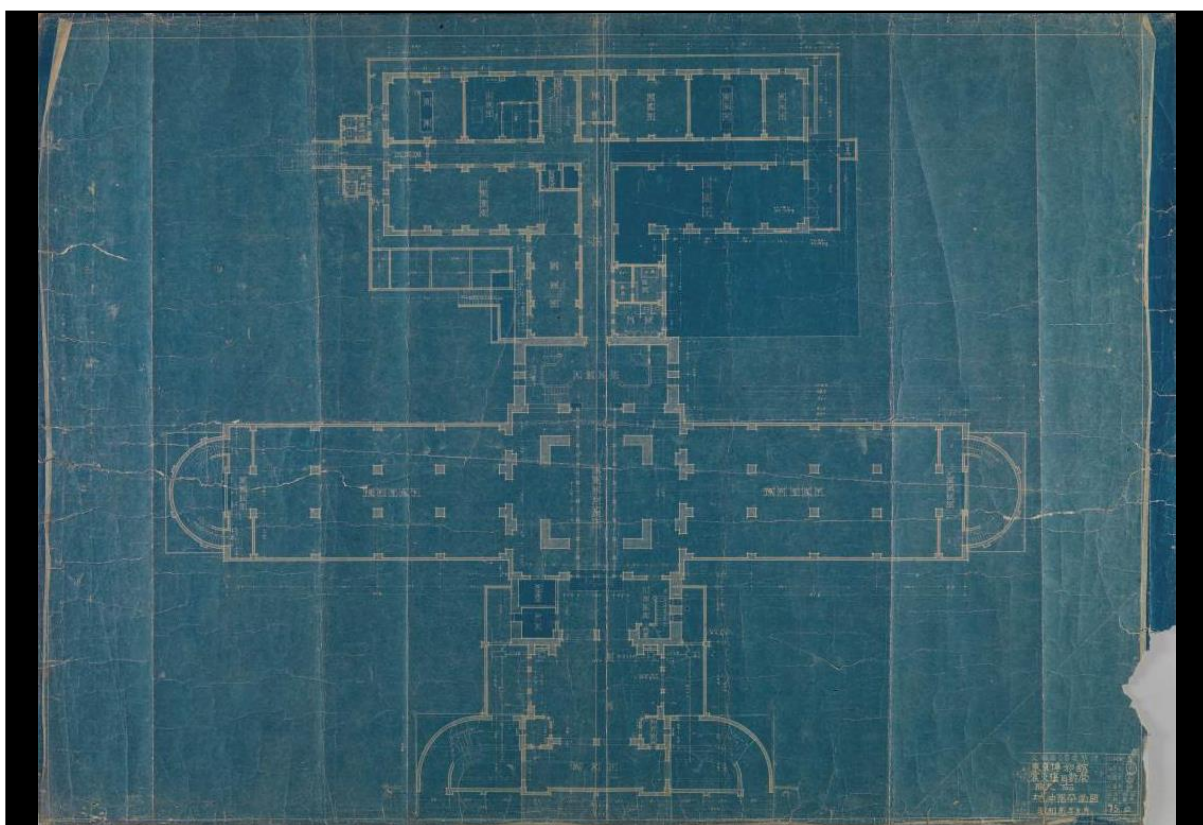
東京科学博物館震災復旧新営工事設計図（地中階平面図）
